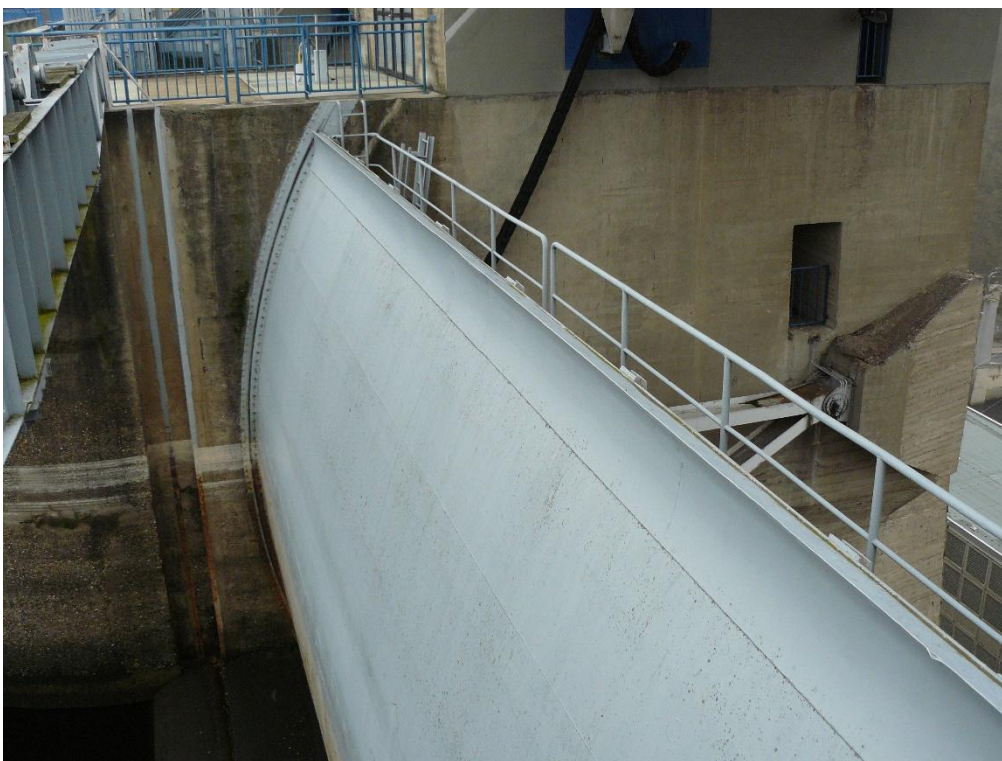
Pohled na segmentový uzávěr po vodě
